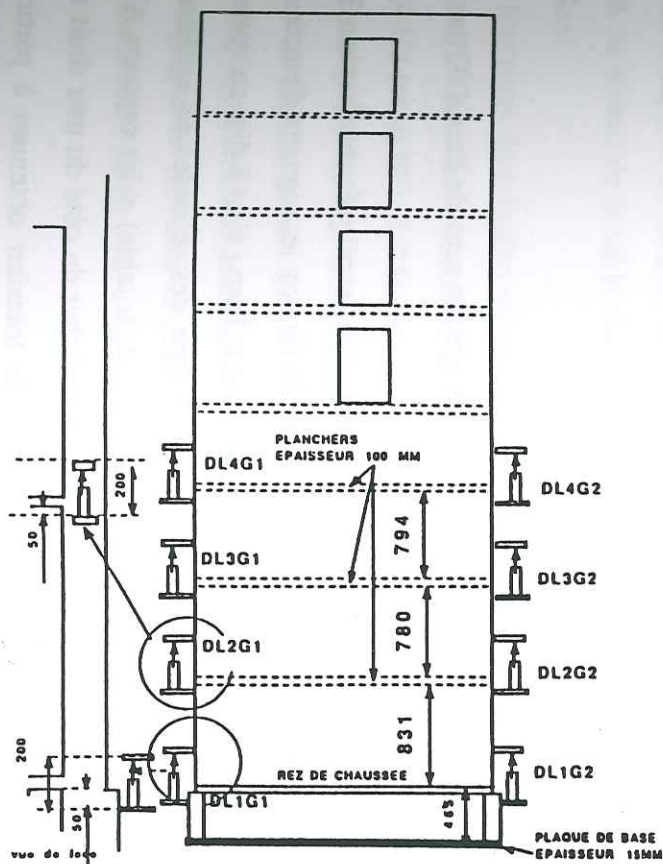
Dispositif de mesure de l'ouverture des fissures à hauteur des planchers - Mur gauche (Gantenbein et al., 1994)
